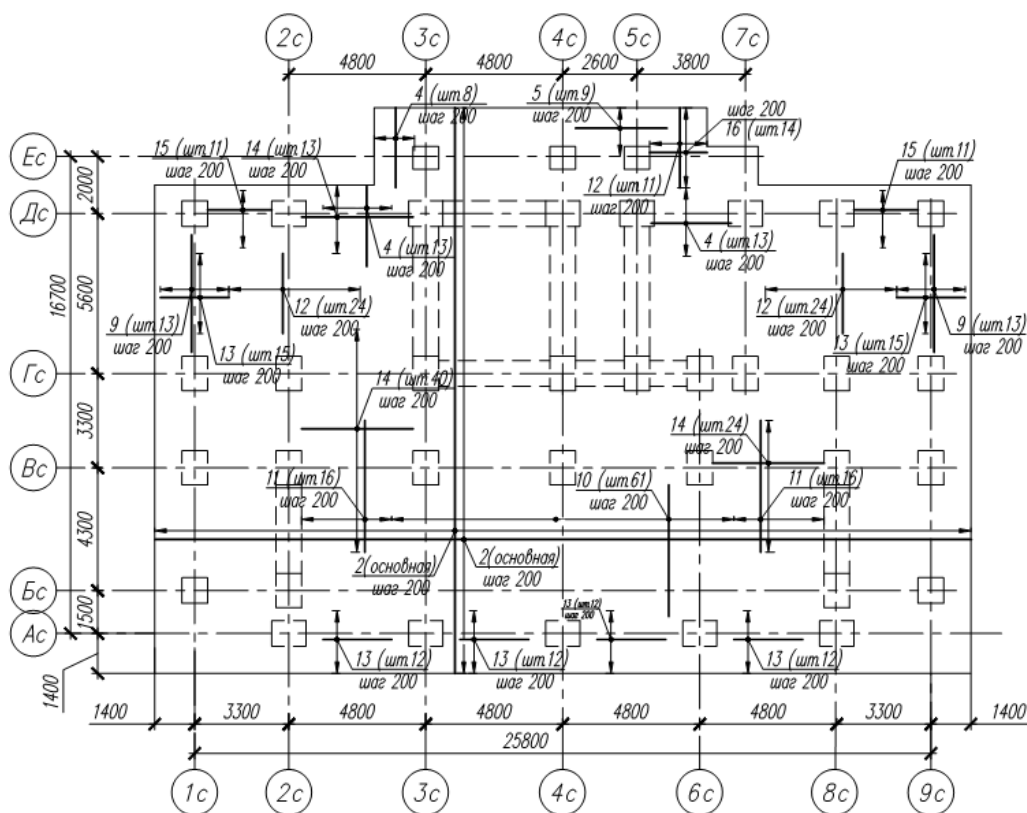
Схема расположения верхней арматуры ж/б фундамента
